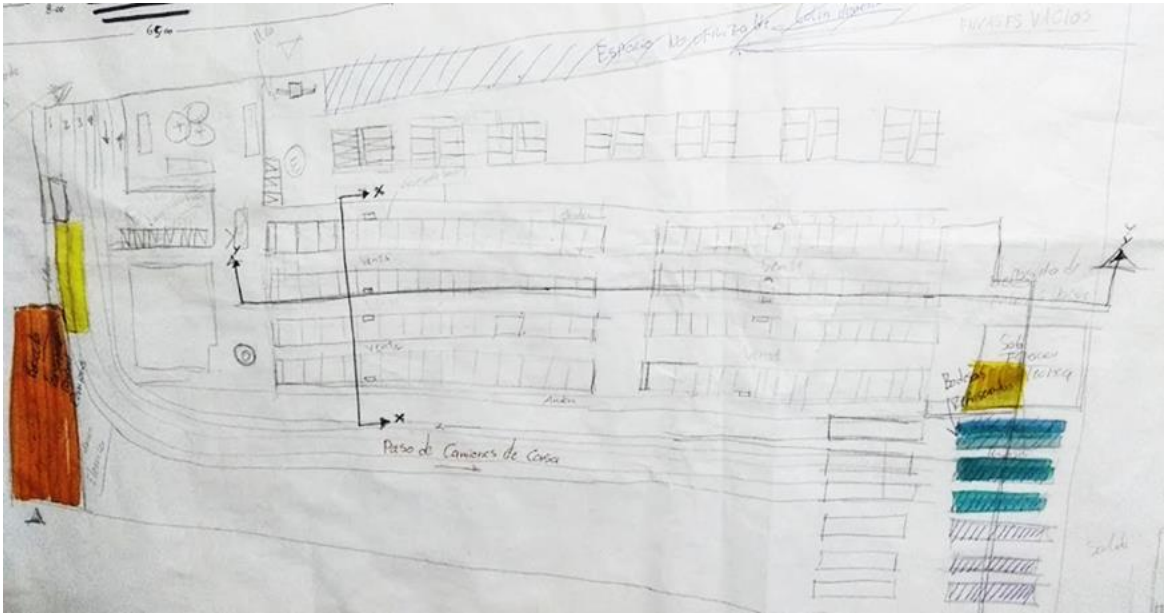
Foto planta arquitectónica, ubicación de estacionamiento, embaces vacíos y área de carga y descarga, Fuente: elaboración propia.
